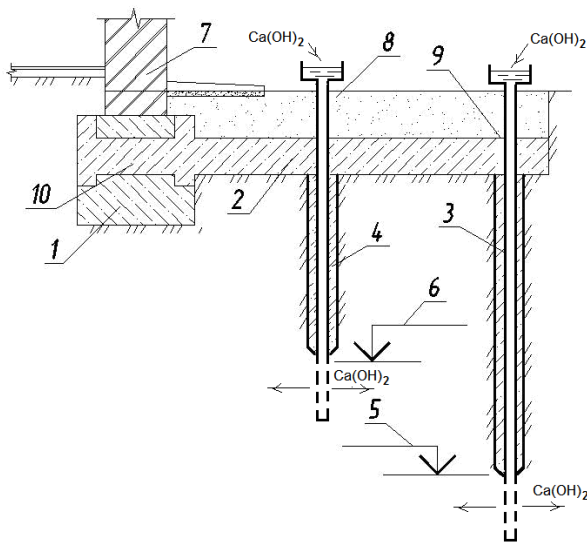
Нагнітання в ґрунт насиченого розчину $Ca(OH)_2$ через бурин'єкційні палі: 1 – фундамент; 2 – монолітна залізобетонна балка; 3, 4 – буронабивні палі; 5, 6 – відмітка низу палі; 7 – стіна; 8 – зворотна засипка; 10 – закладення балки у фундамент
